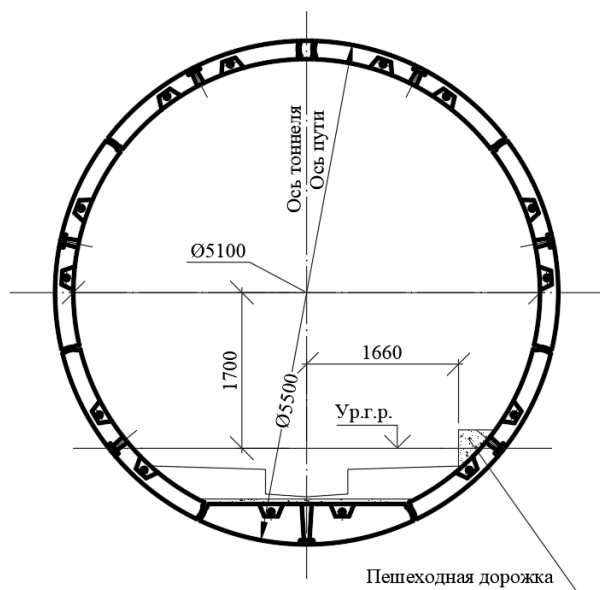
Обделка тоннеля из железобетонных ребристых блоков.
